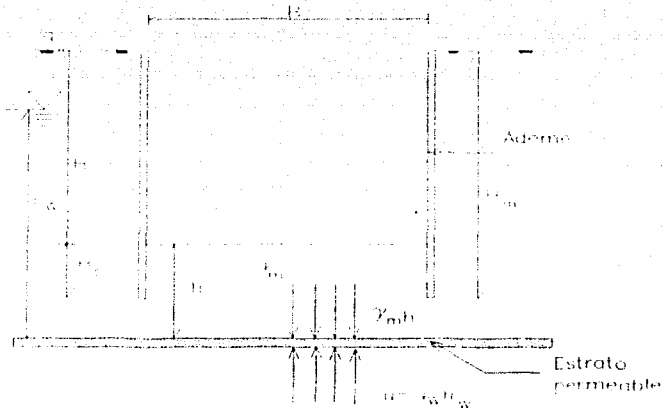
GEOMETRIA DE UNA EXCAVACION
